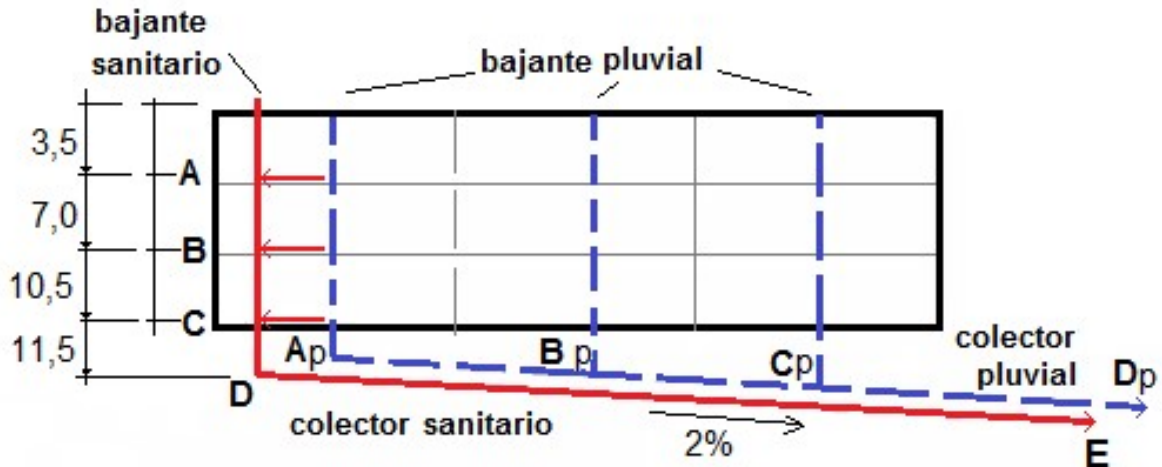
Esquema en elevación para el cálculo de columnas y maestras
